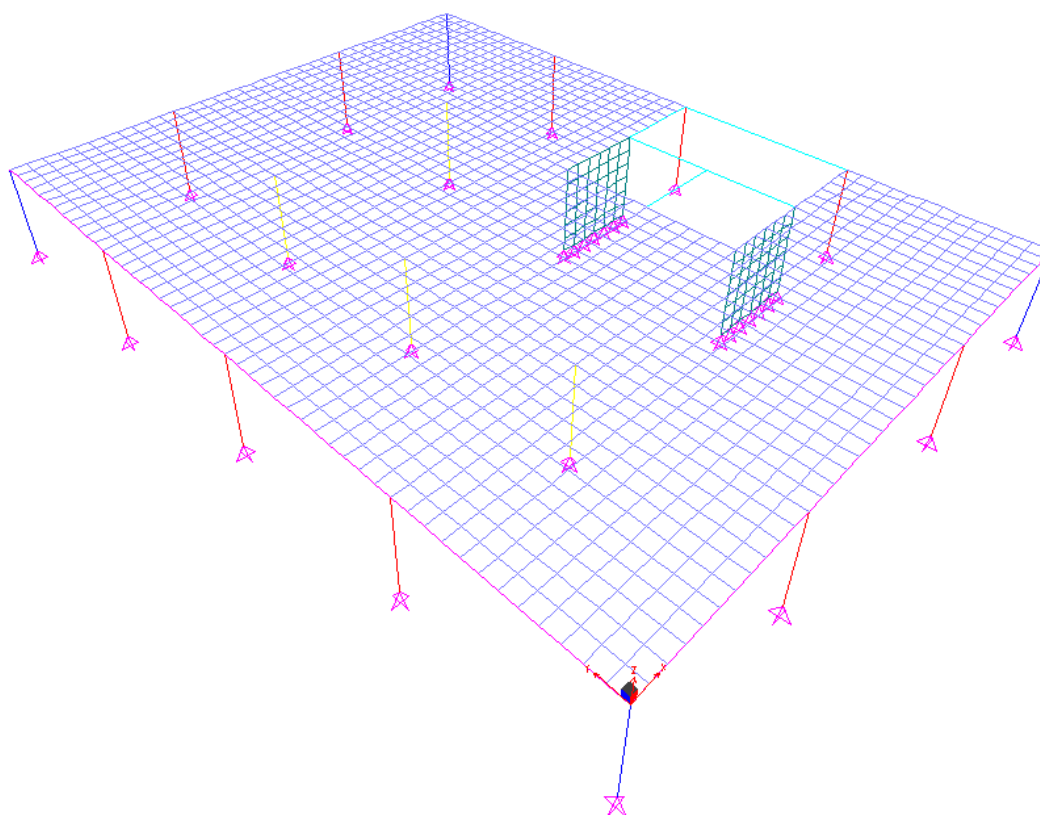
Estrutura do pavimento tipo em eixos médios via SAP2000
